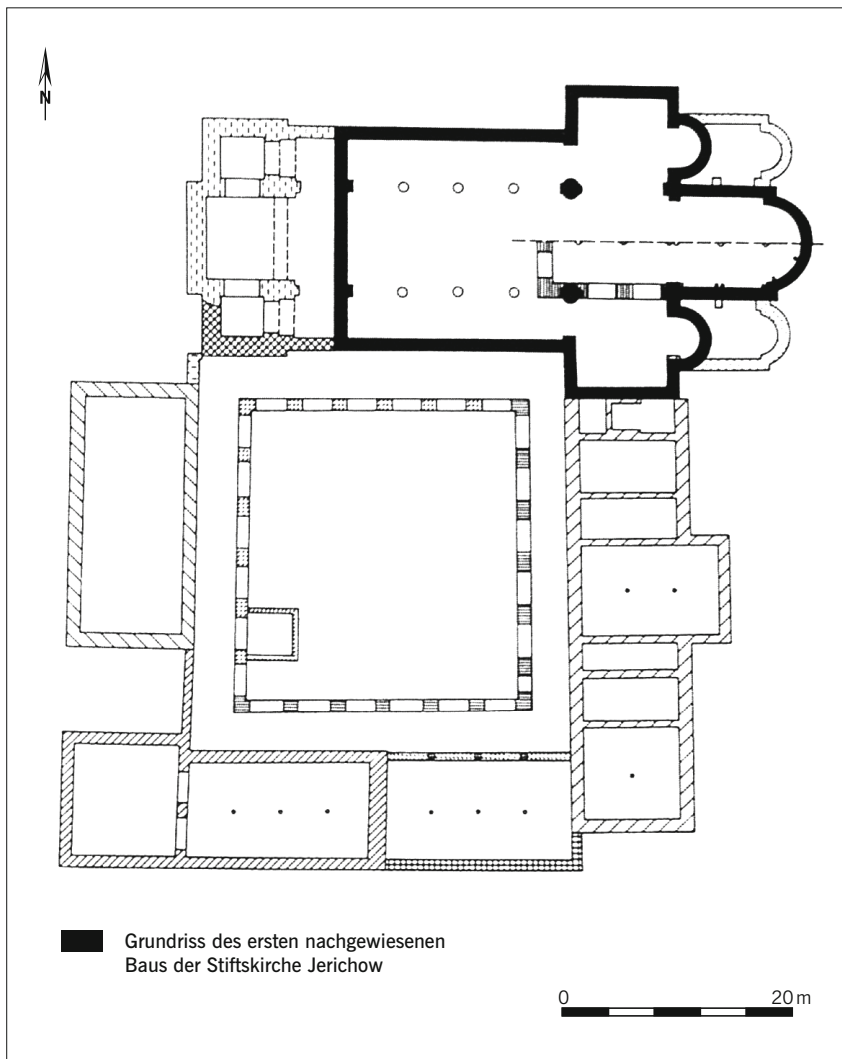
Bei dem Grundriss des ersten nachgewiesenen Baus der Stiftskirche Jerichow mit Backsteinausführung handelt es sich um eine Basilika. Die Hauptapsis, in deren Außenwand die beiden Bacini eingefasst sind, gehört mit zu dieser Bauphase.
